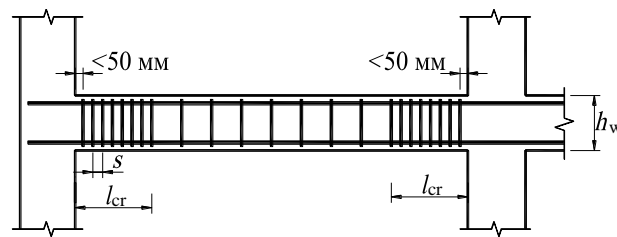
Поперечное армирование в критических зонах балок
